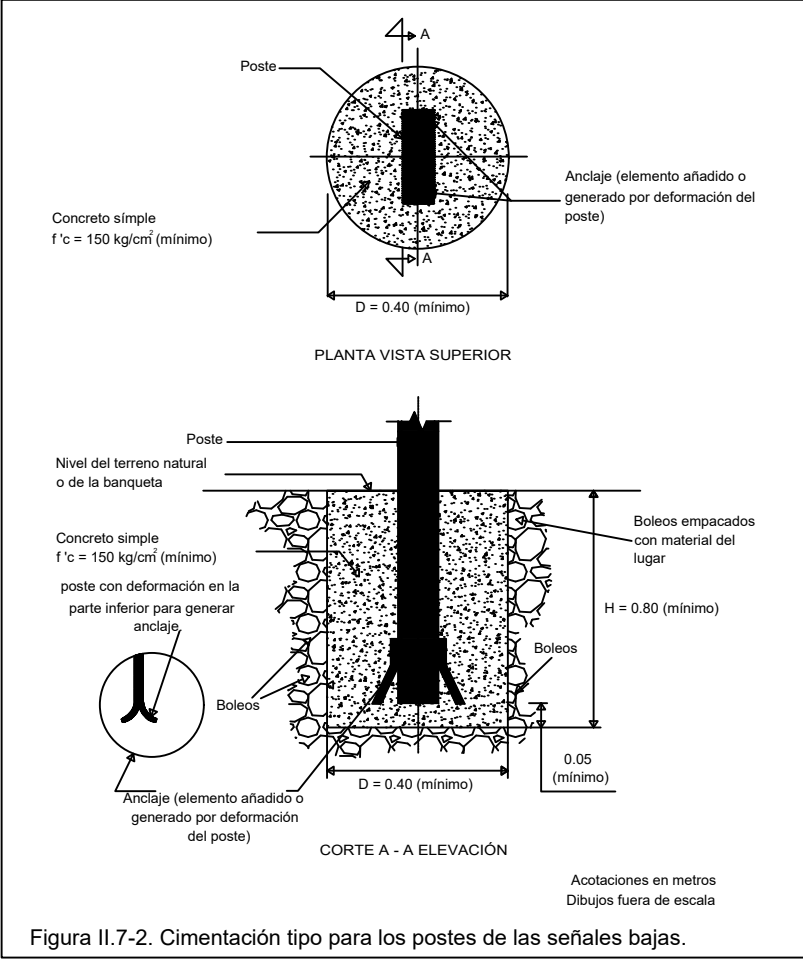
Cimentación tipo para los postes de las señales bajas.
